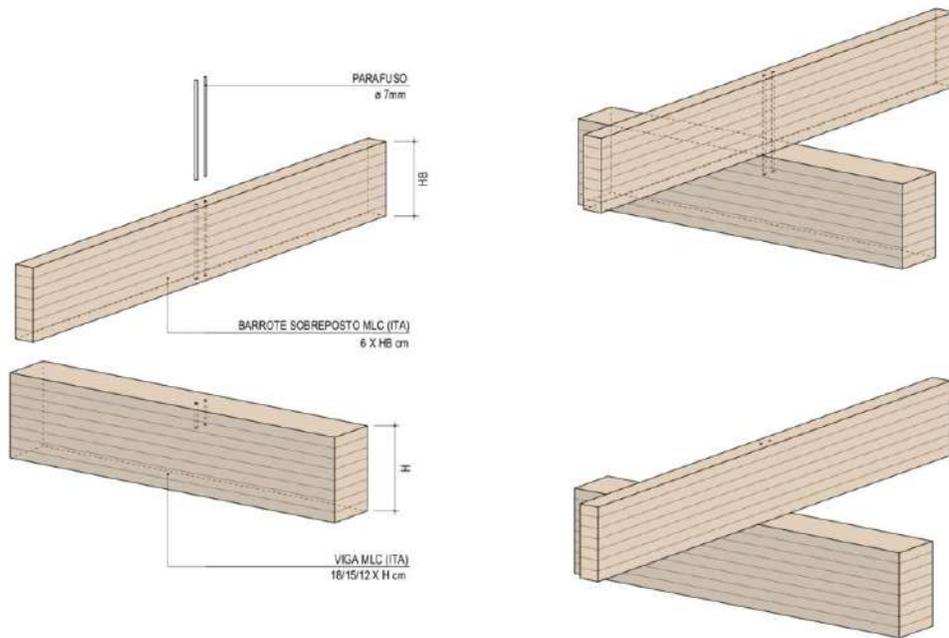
Detalhamento construtivo da fixação do barrote sobreposto na viga. (fonte: Ita Construtora)
